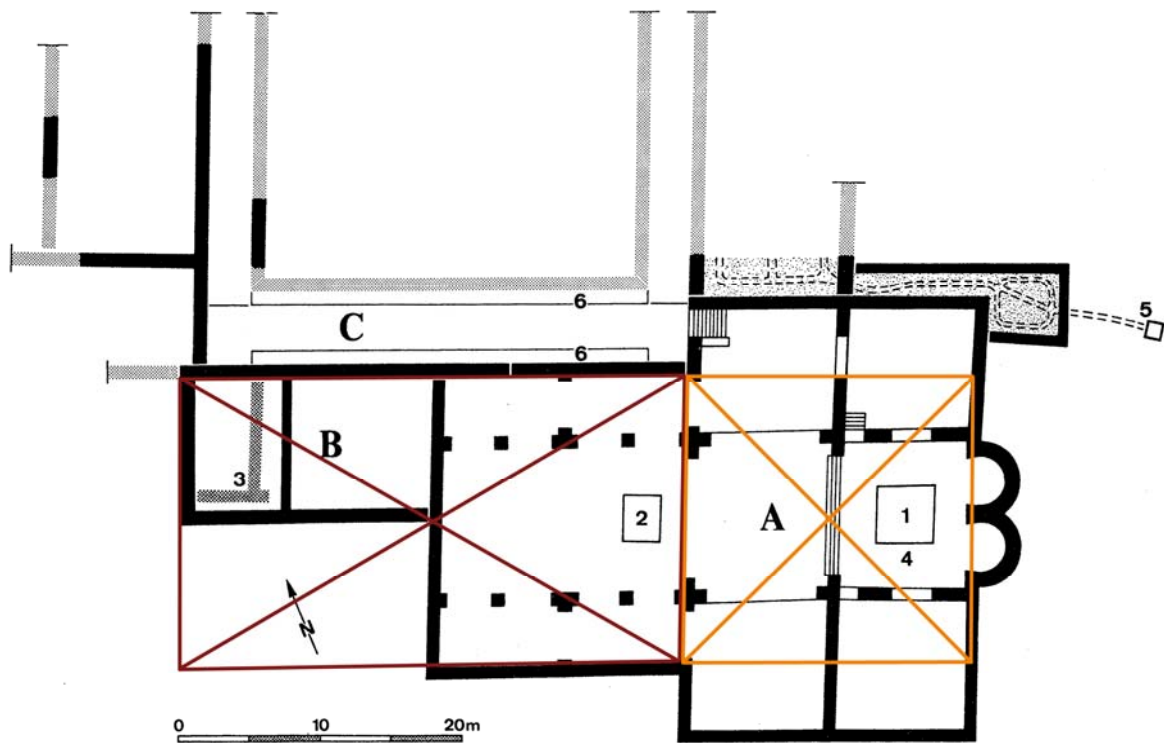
Klosterkirche Reichenau-Mittelzell. Grundriss mit Absteckschema. Grundlage: ZETTLER, Klosterbauten (wie Anm. 96) S. 175.
